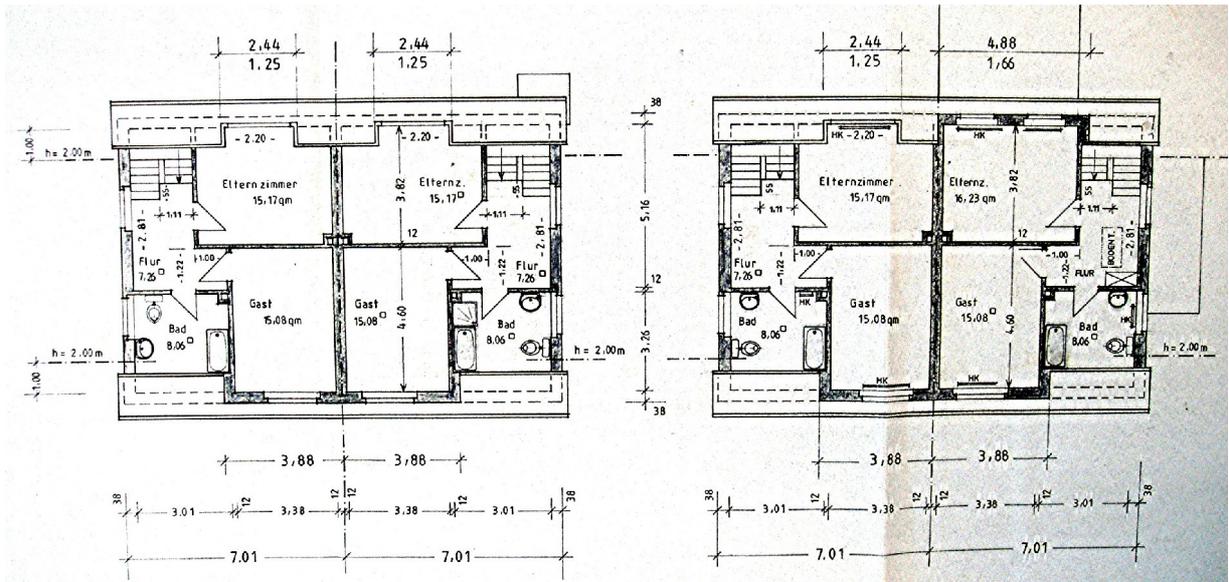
Grundrisse Dachgeschoss der Häuser Nr. 48 (ganz rechts), 50, 52 und 54 (ganz links)⁴⁶
